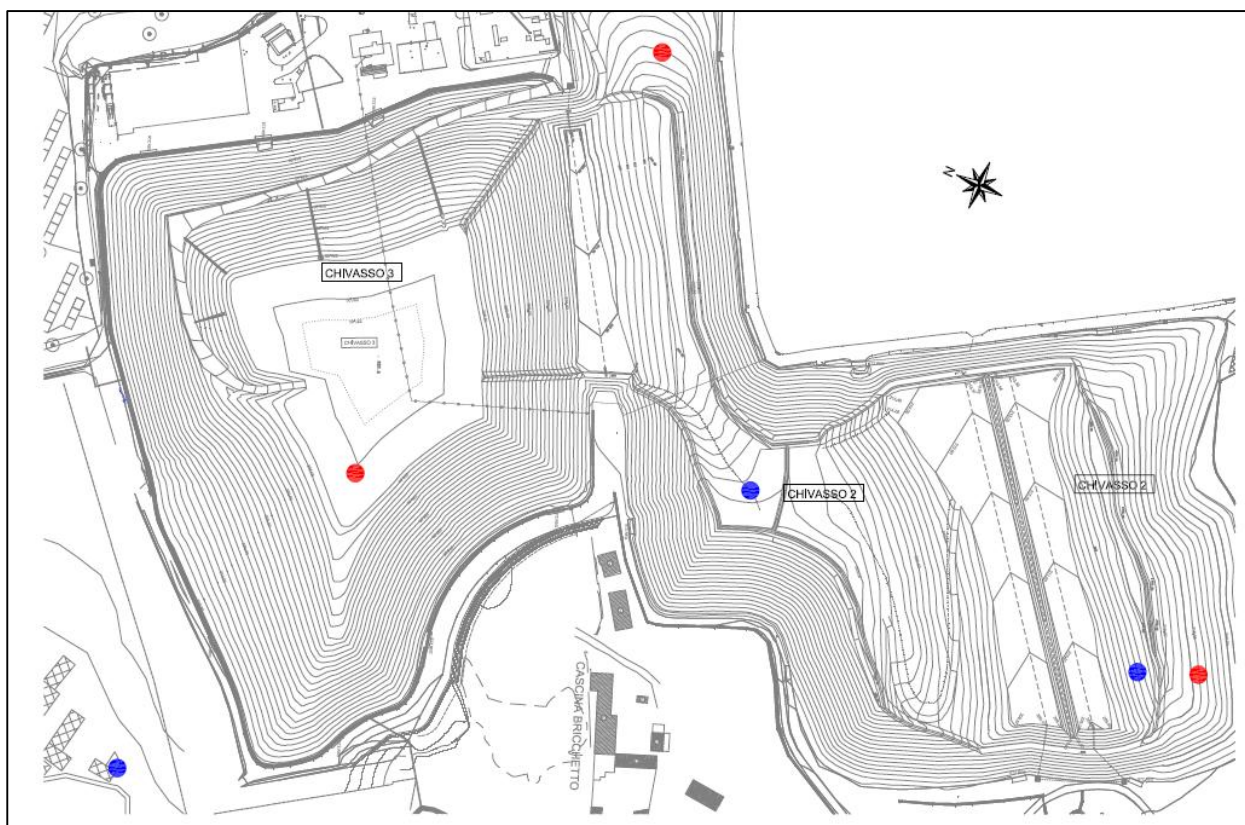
Estratto planimetrico con l'ubicazione delle termocamere
